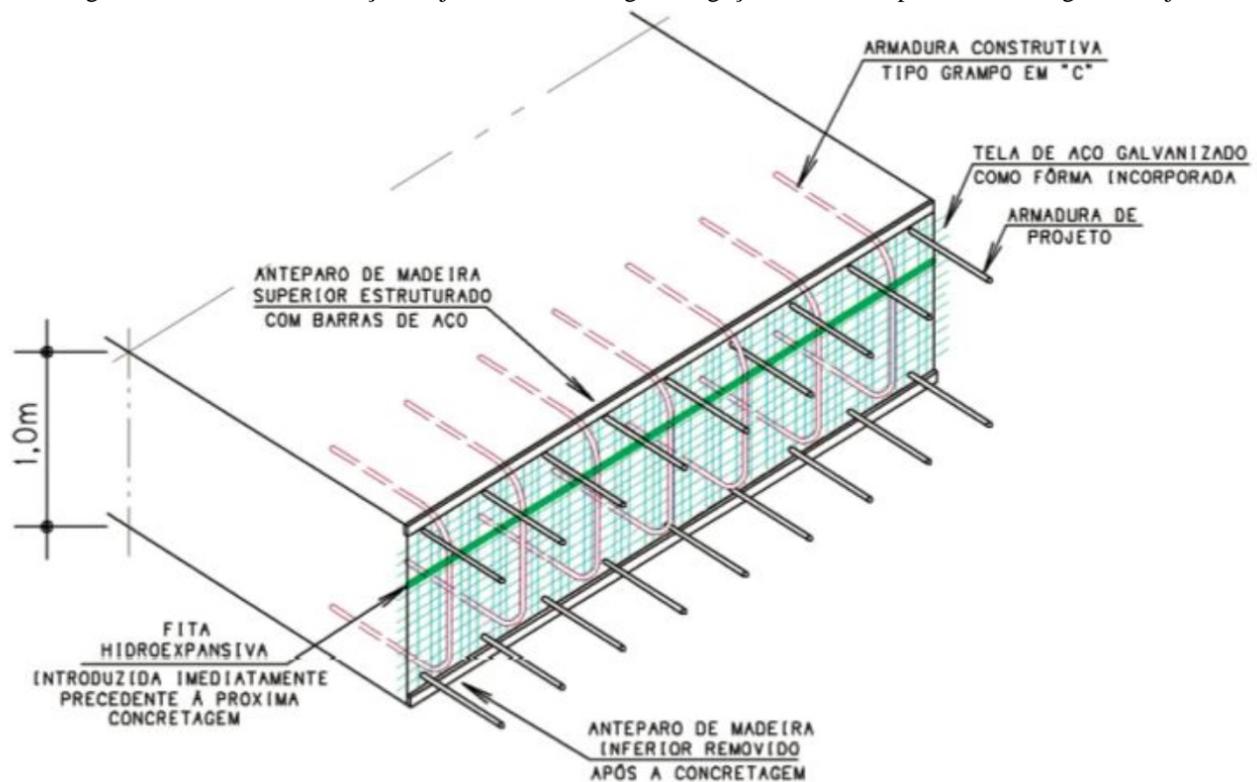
Detalhe de execução de junta de concretagem - ligação entre as etapas de concretagem da laje
